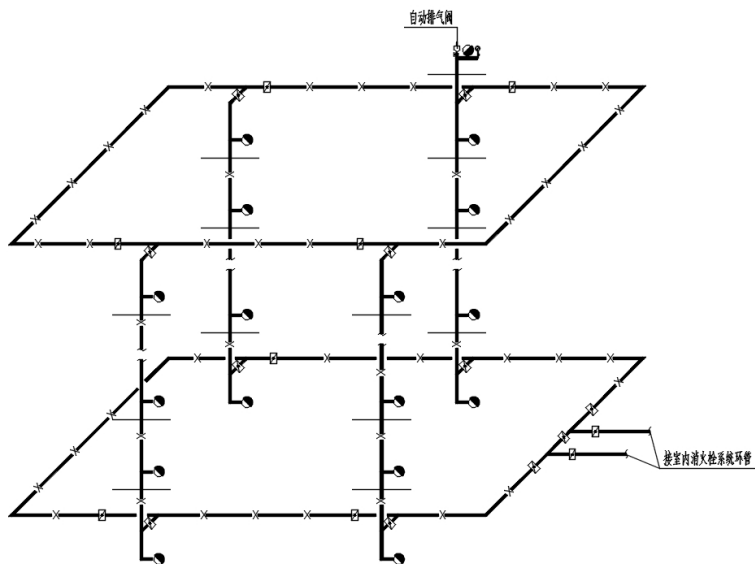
室内消火栓系统立体环网布置示意图
